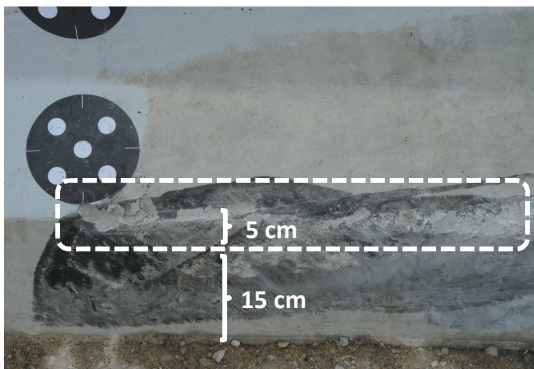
Detalle zona de impacto de la llanta con el perfil (2º ensayo, perfil 51).
